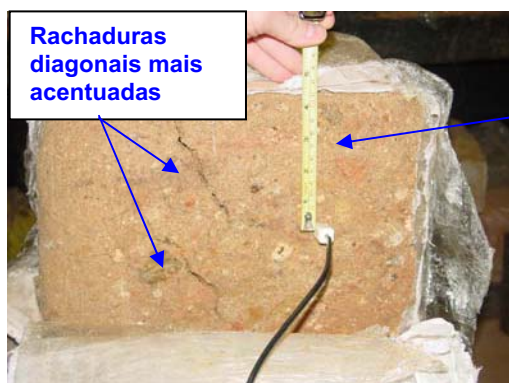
Ensaio em andamento na face 03 do bloco (rachaduras mais acentuadas), ponto 3.1
